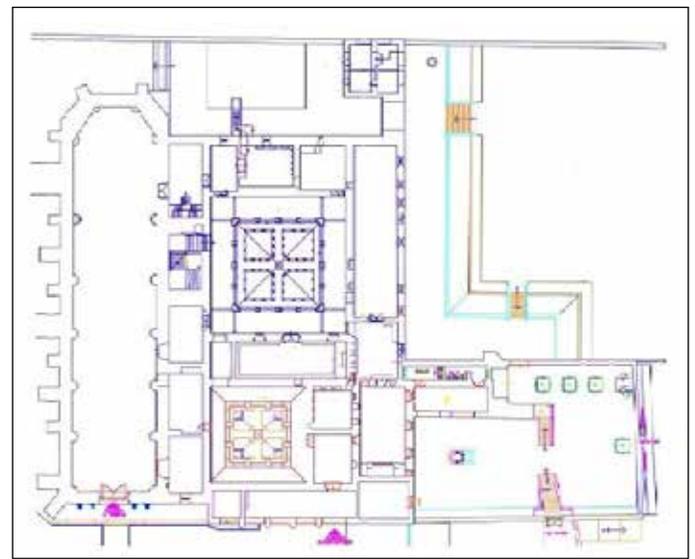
Plano de la planta baja del Museo de Acolman.
